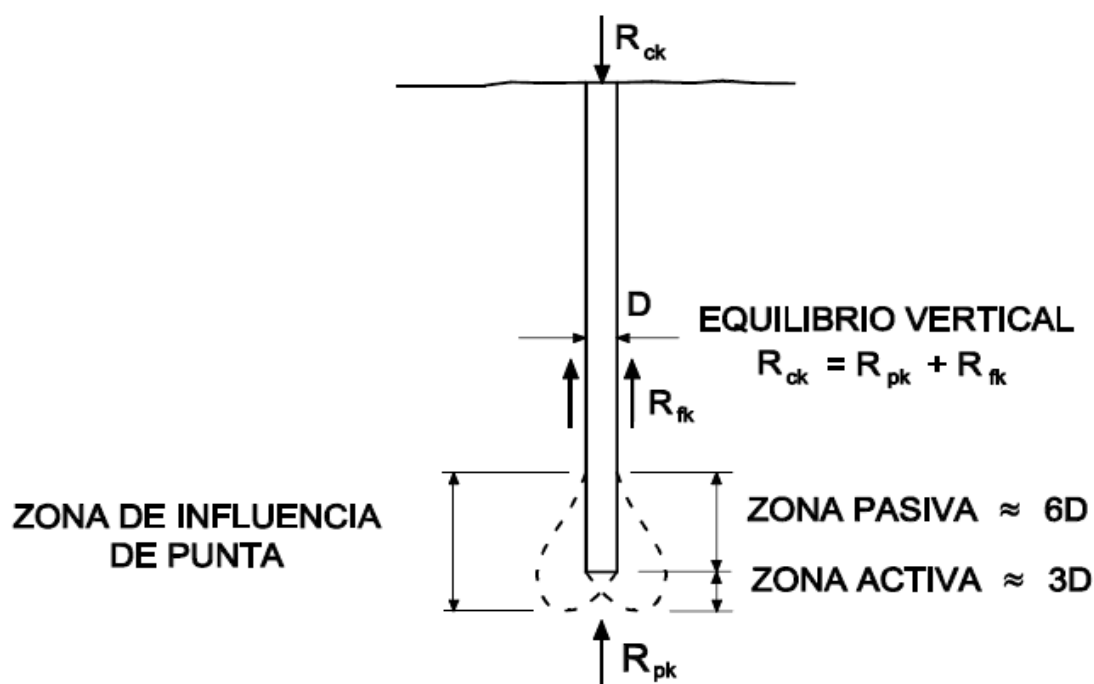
Esquema de distribución de la carga de un pilote aislado (fuente: CTE-SE-C).
